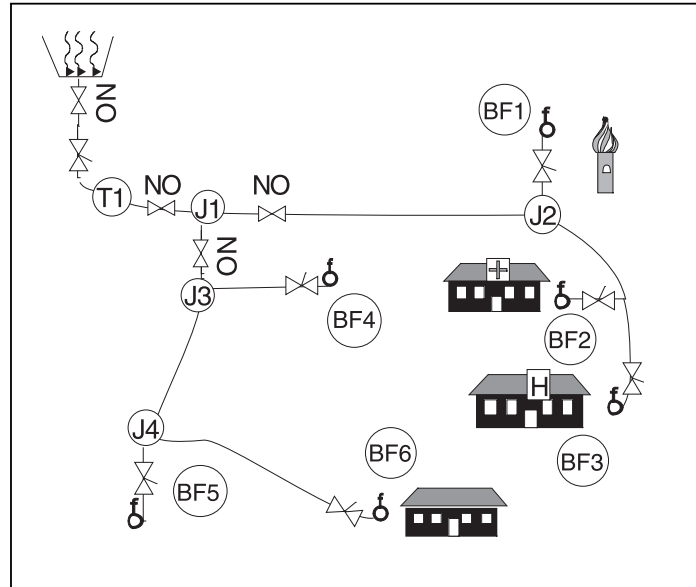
Plan de vannage minimal du réseau d'Aloua (hors vidanges et purges d'air).
